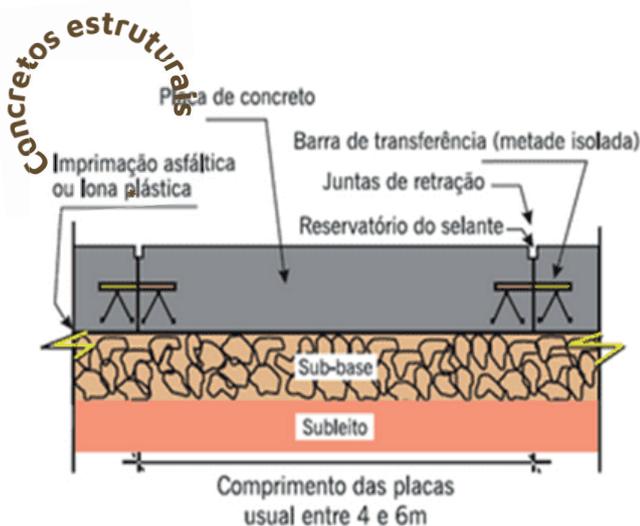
Piso de concreto armado. Fonte das imagens: google imagens, <https://www.concrepav.com.br/concreto-pavimento-rigido>
